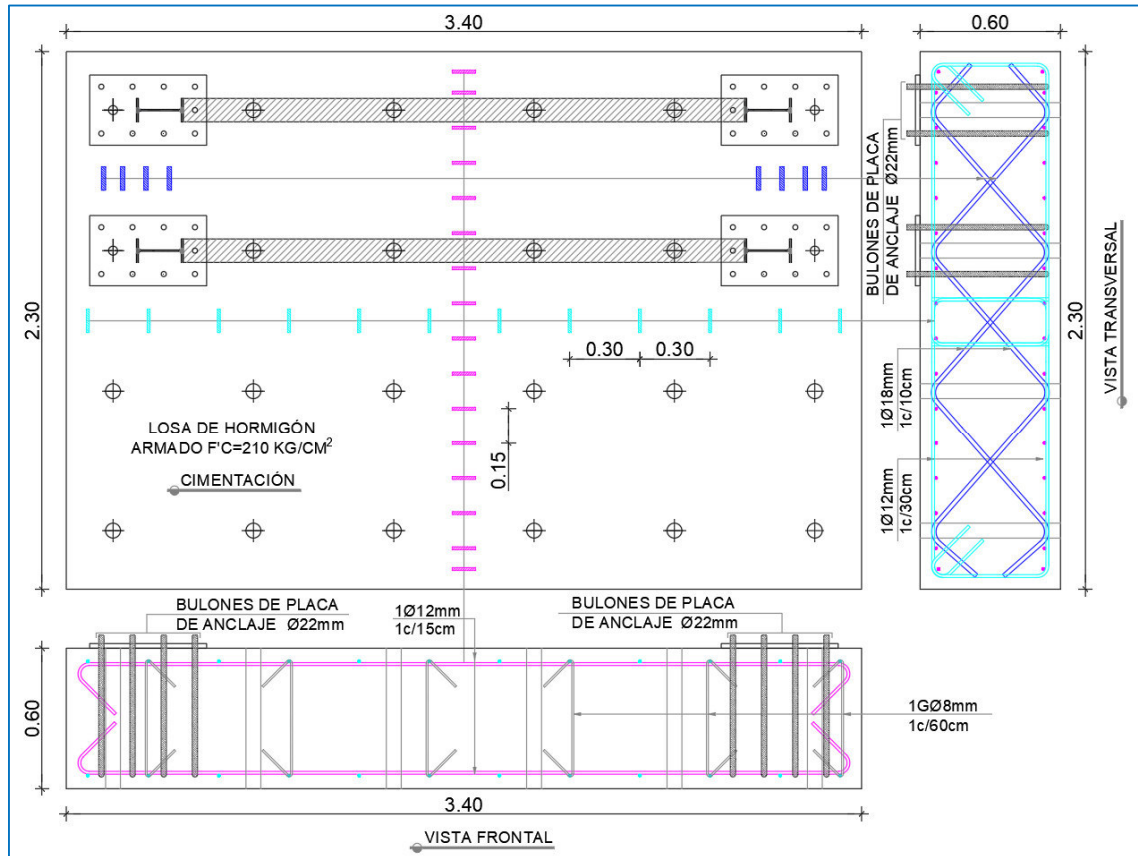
Armado longitudinal y transversal de cimentación de prototipos.
